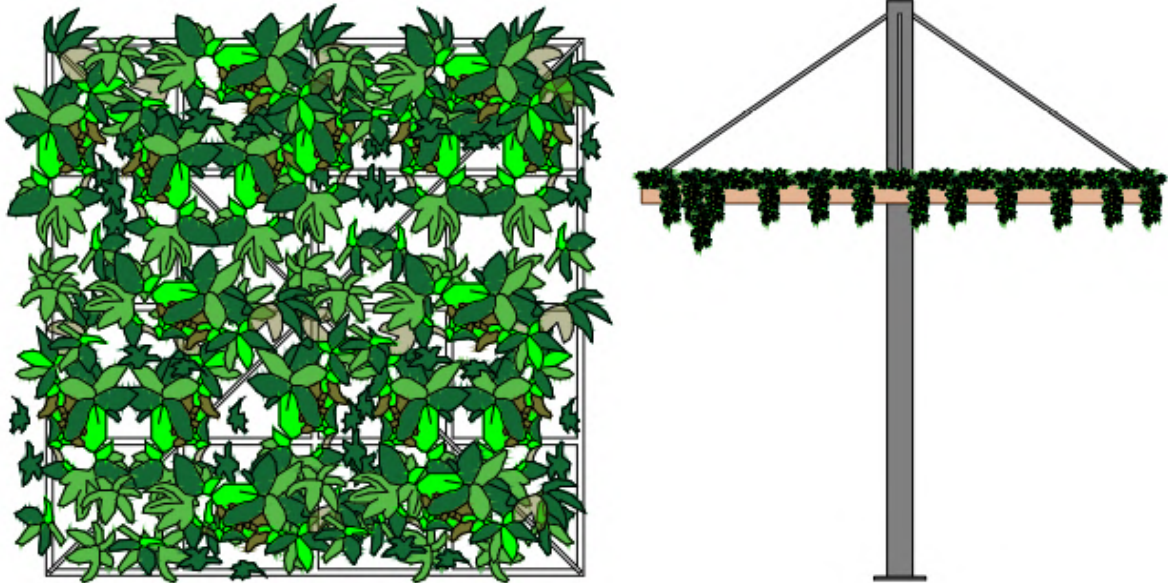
Cubiertas exteriores. Fuente: Elaboración propia.
